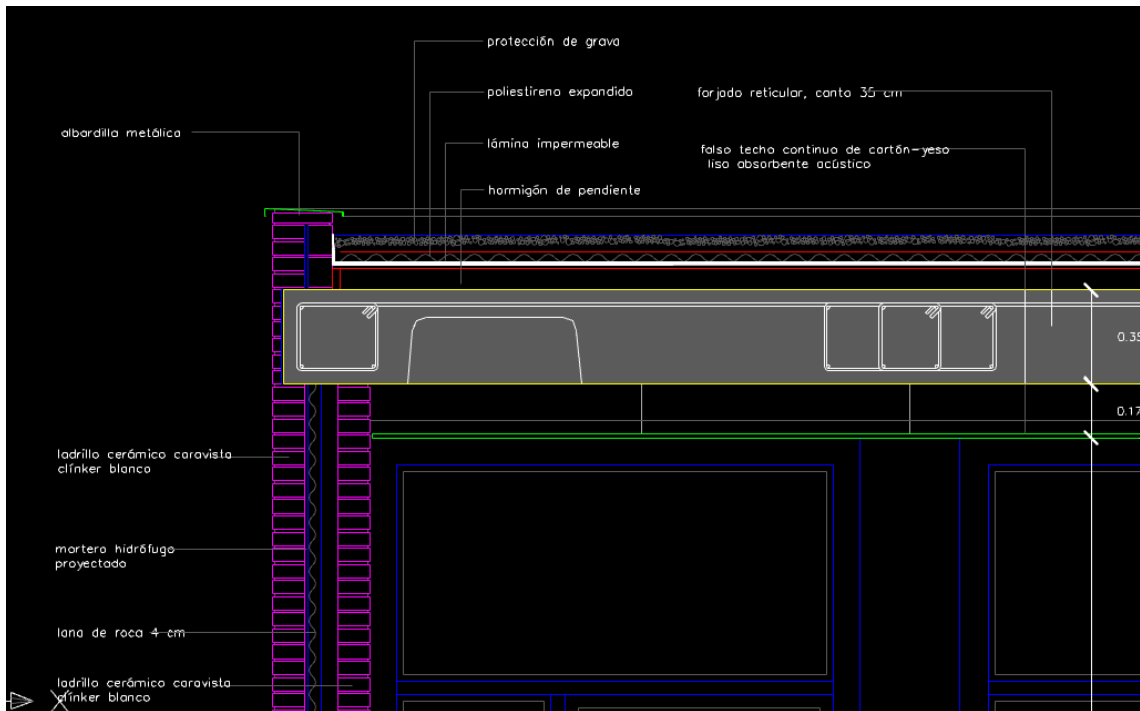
Cubierta invertida en plano de sección, obtenido del proyecto de ejecución.
